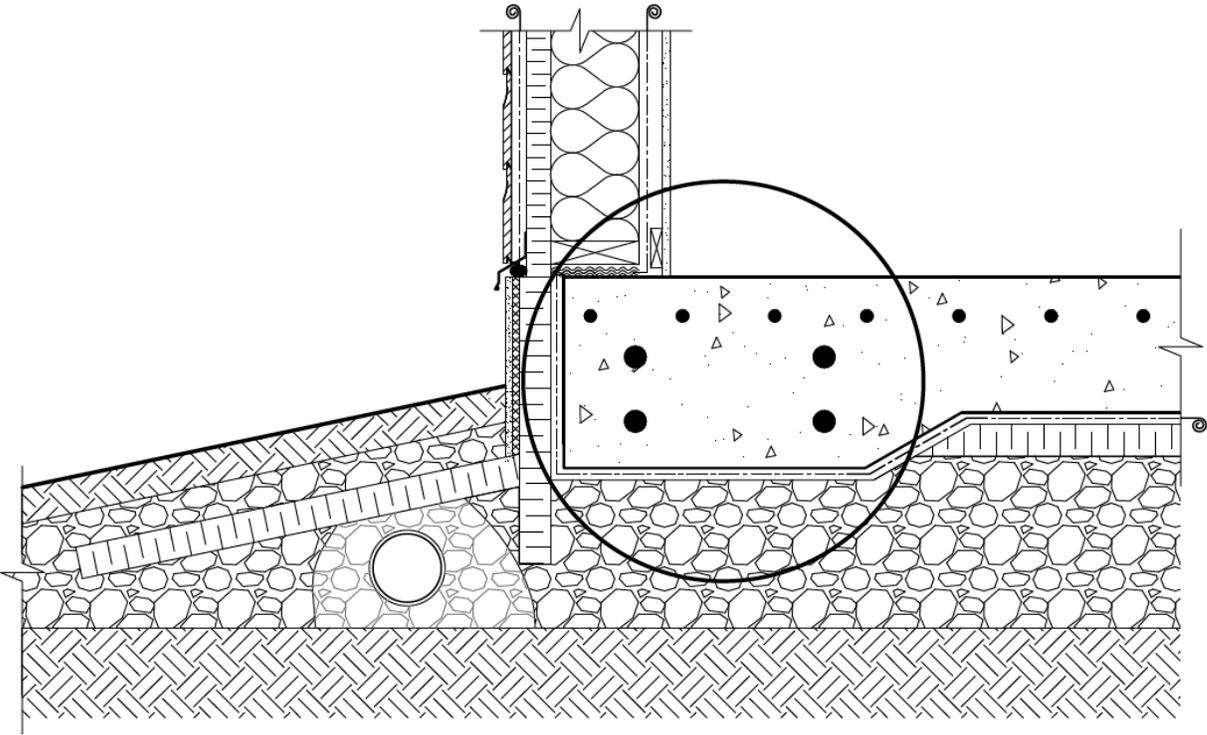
Chevauchement de 2 plans d'isolation distincts pour un mur en blocs de béton
